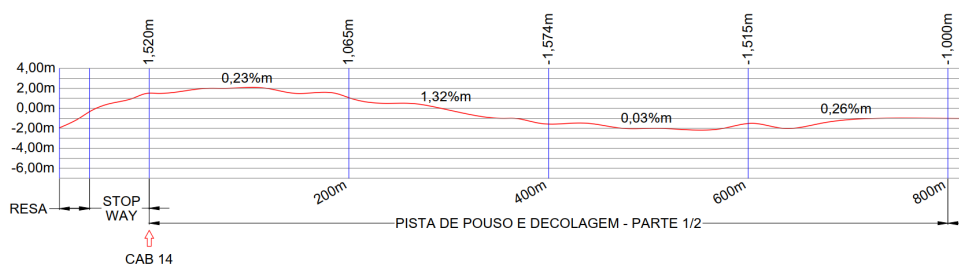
Perfil longitudinal do local escolhido para implantação da Pista de Pouso e Decolagem – Parte 1 de 2.
